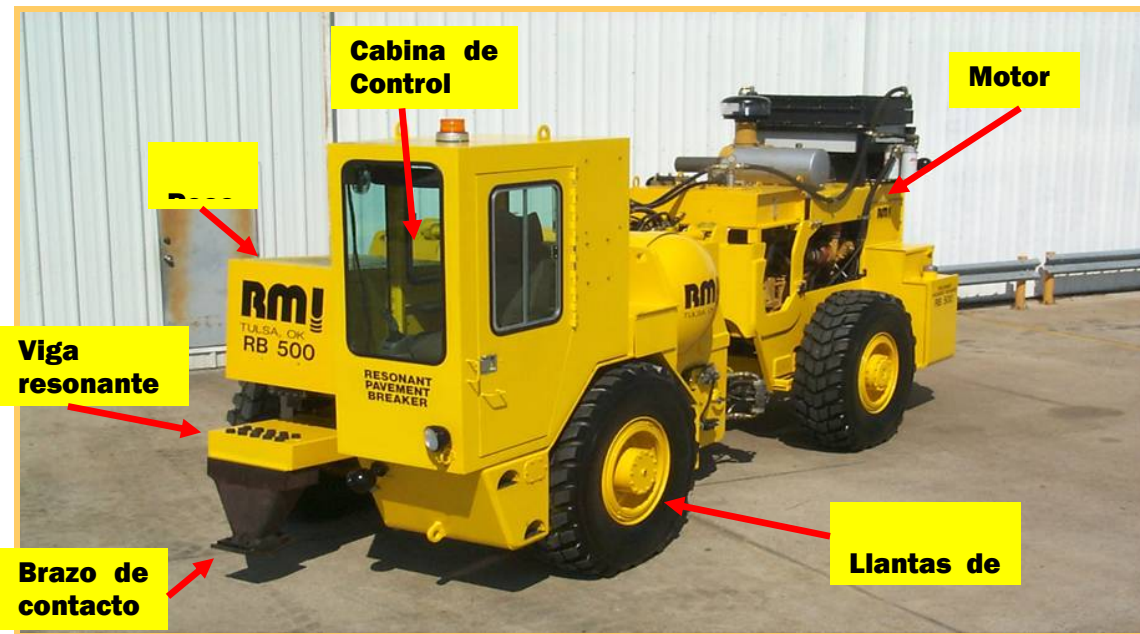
Partes principales de un equipo rompedor resonante de pavimento (resonant pavement breaker) modelo RB 500 (RMI, Inc.).
